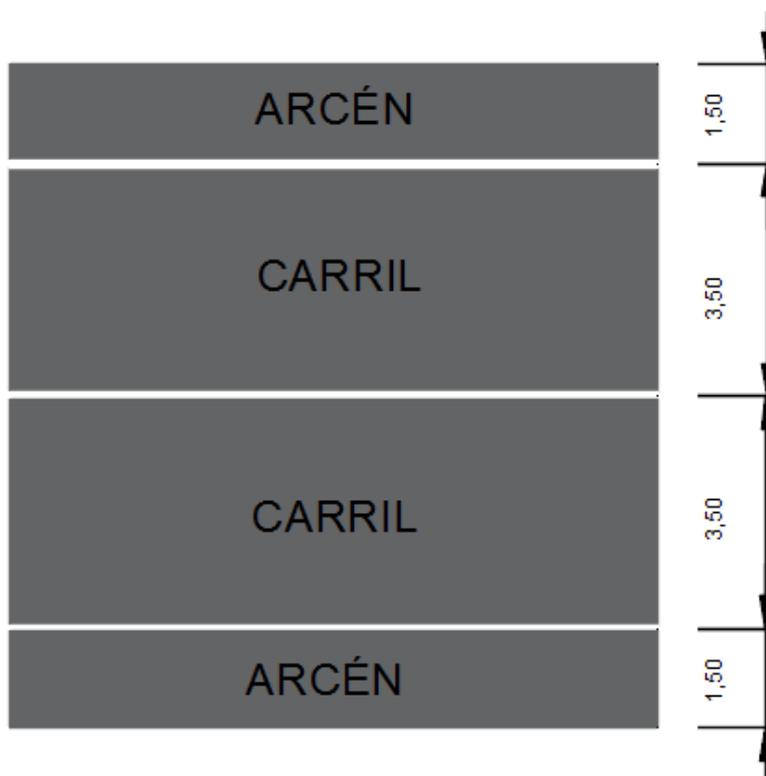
Sección transversal tramo no de montaña (medidas en metros).
